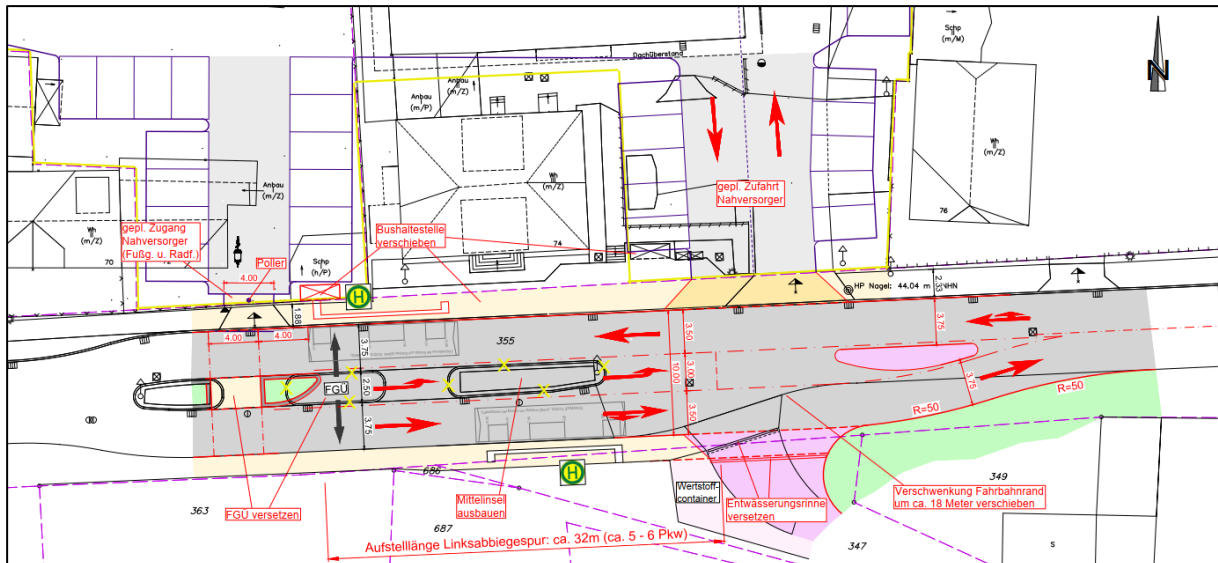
Lageplan der geplanten Zufahrt, Vorplanung Stand 06.05.2025, Wunderlich GbR
